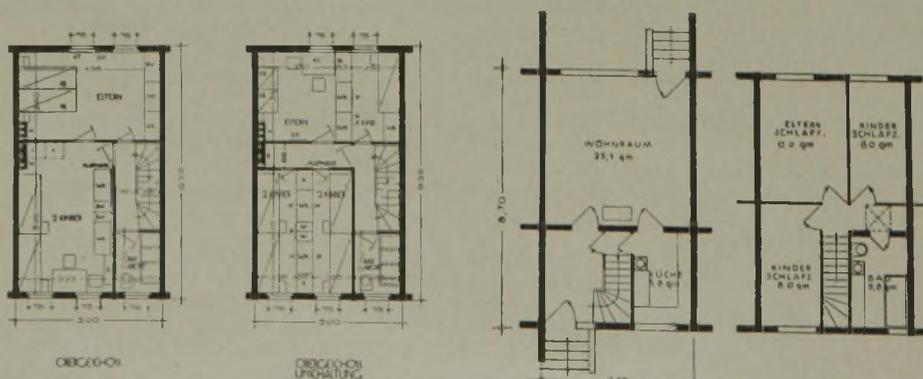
(links). Grundrisse vom Kleinhaus des B. D. A. (Umschaltung durch verstellbare Wände und Schrankwände. (1:250.)
